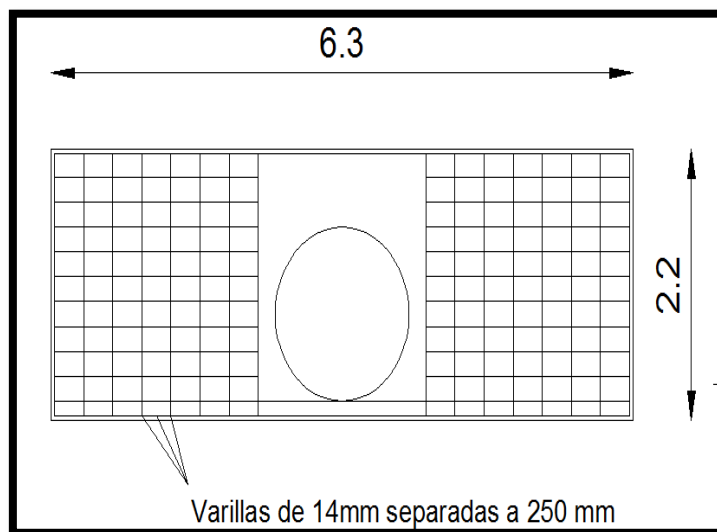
Elevación frontal de cabezal para alcantarilla de 1600mm.
